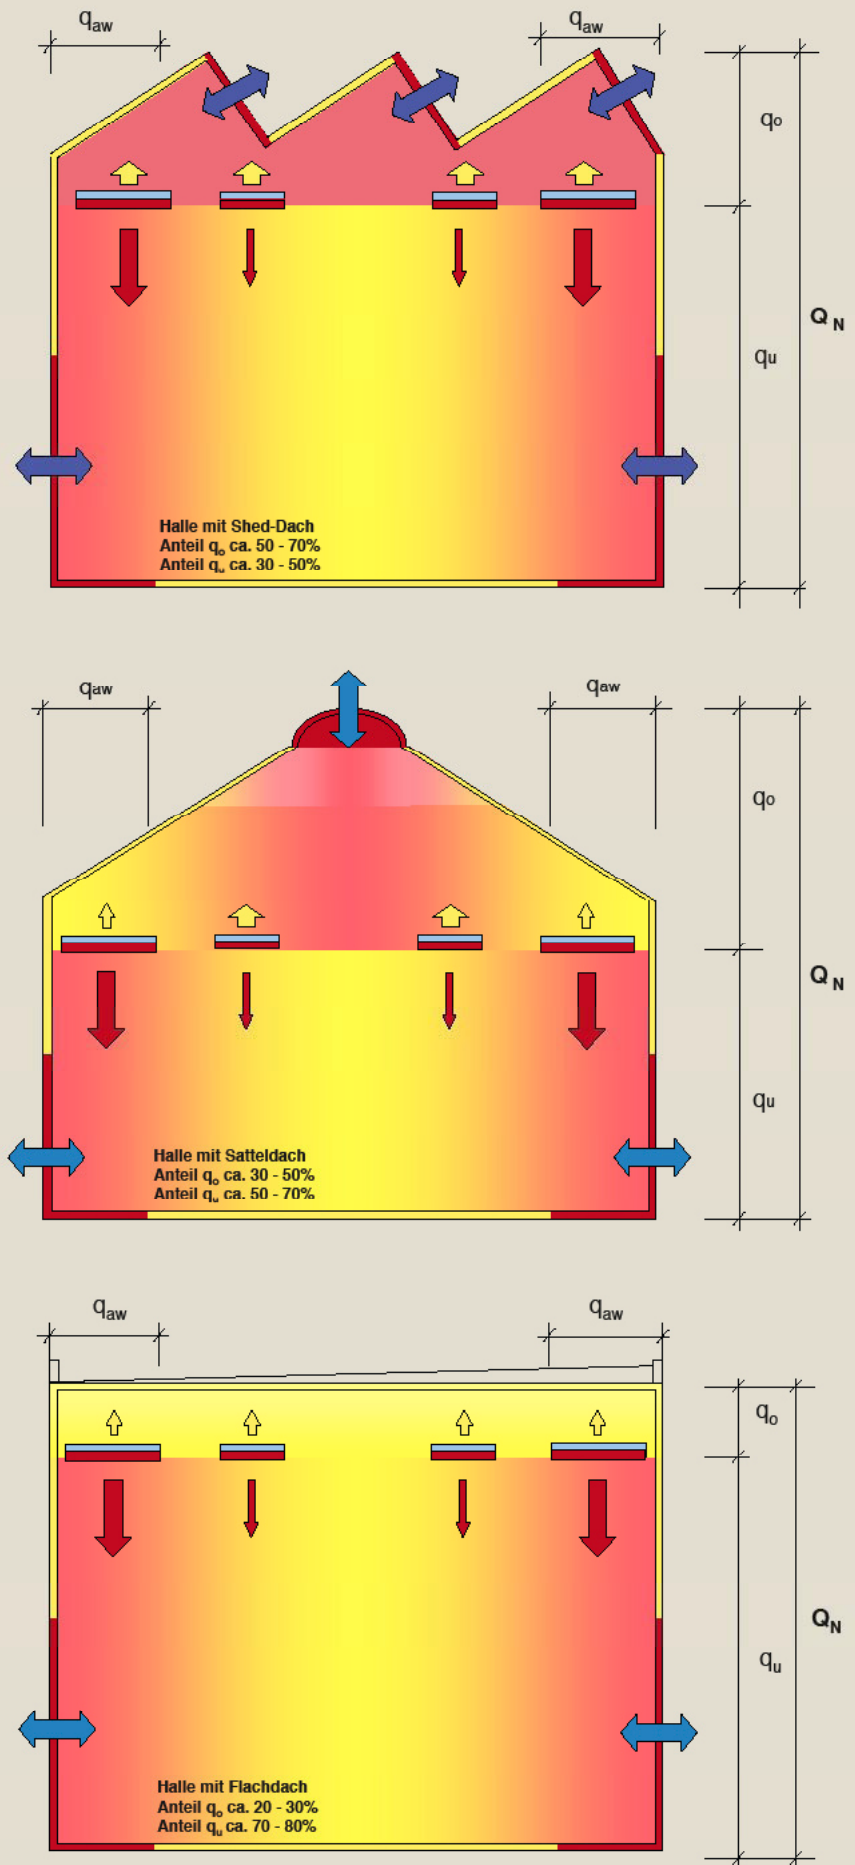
Typische Hallenquerschnitte mit ihren charakteristischen Werten. Oben: Shed-Dach, Mitte: Satteldach, unten: Flachdach.
